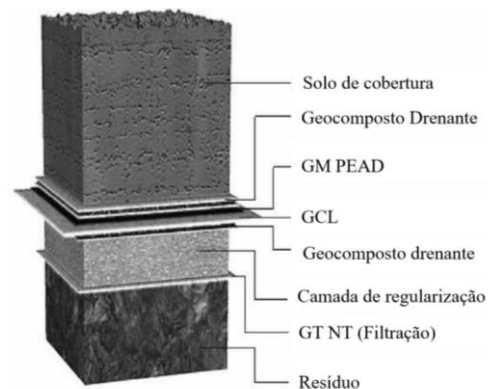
Exemplo de aplicação de GCLs como barreira impermeabilizante de cobertura final de resíduos (HEERTEN, 2002 apud PIMENTEL, 2008).
